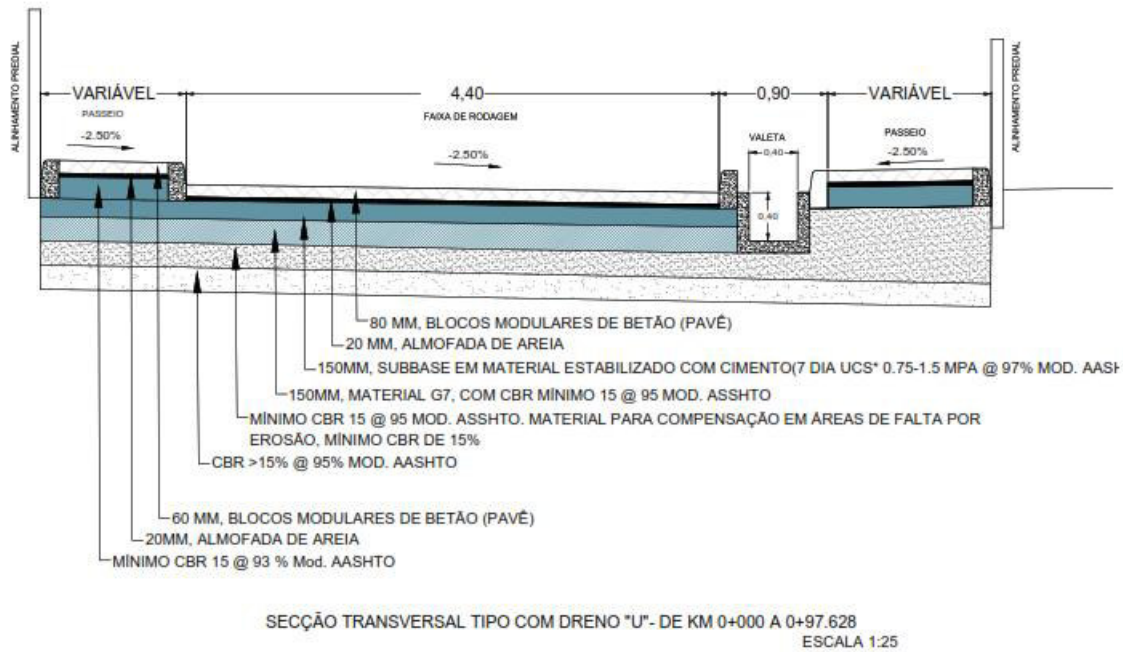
Secção da estrutura de pavimento recomendada (Vala Lateral Rectangular)
